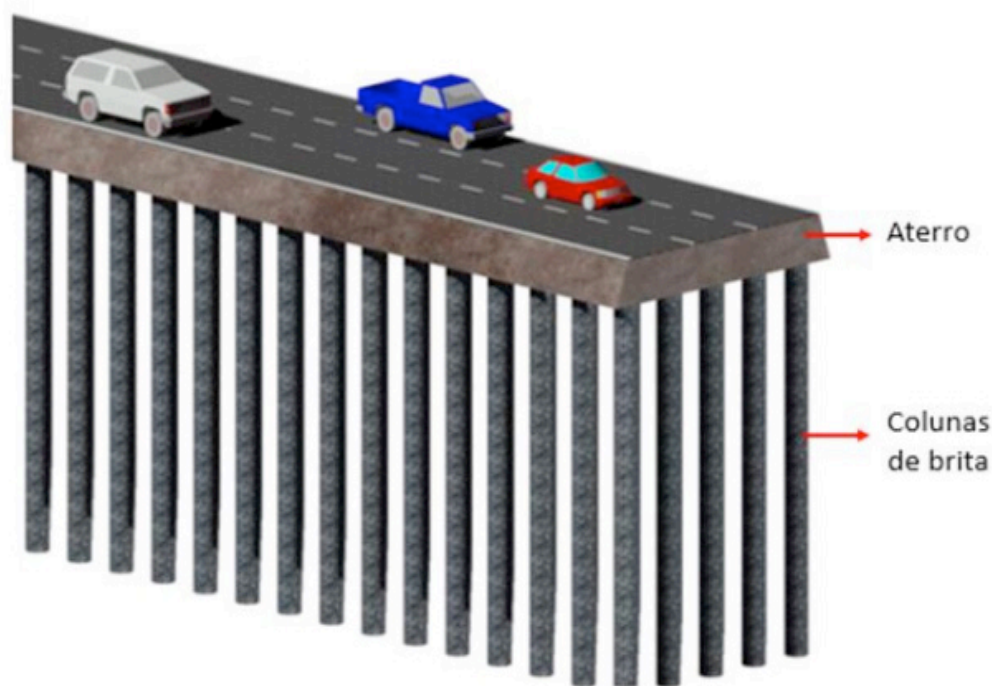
Geometria 3D - Faixas de circulação (Adaptado de Ignacio, 2016)
